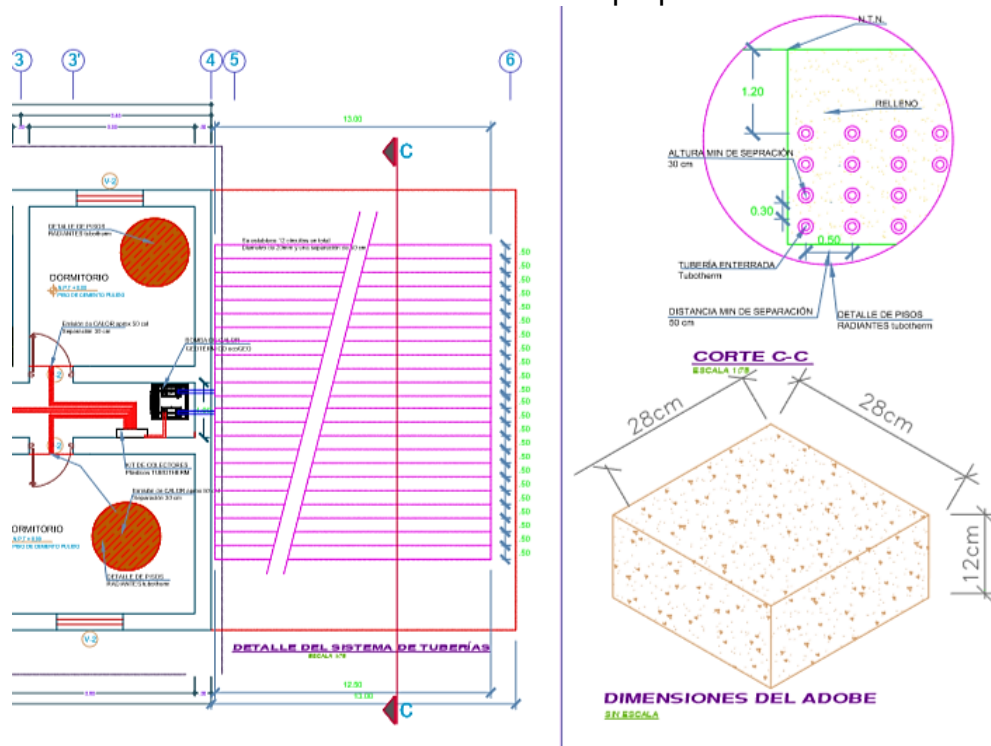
Plano del sistema de tuberías geotérmicas, Esc. 1/75
